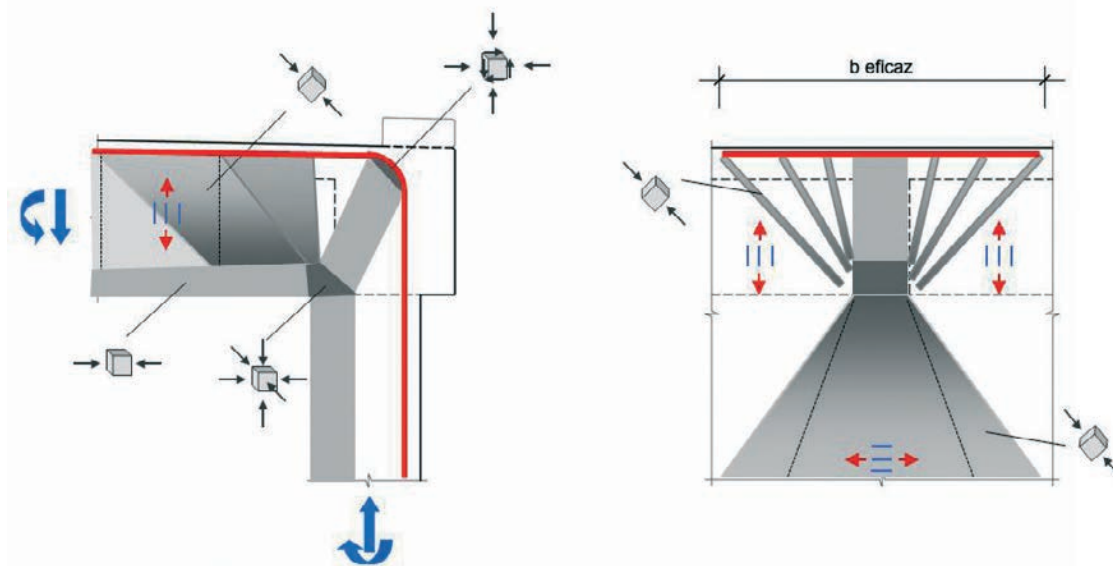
Representación esquemática del comportamiento de un nudo entre una viga con losa superior y un muro para el caso de tracción en la cara exterior; a) Sección; b) Alzado desde el exterior del muro.
